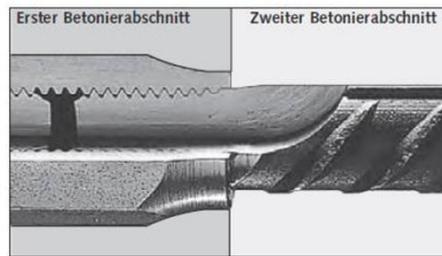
Vollständig eingeschraubtes Anschlussgewinde
